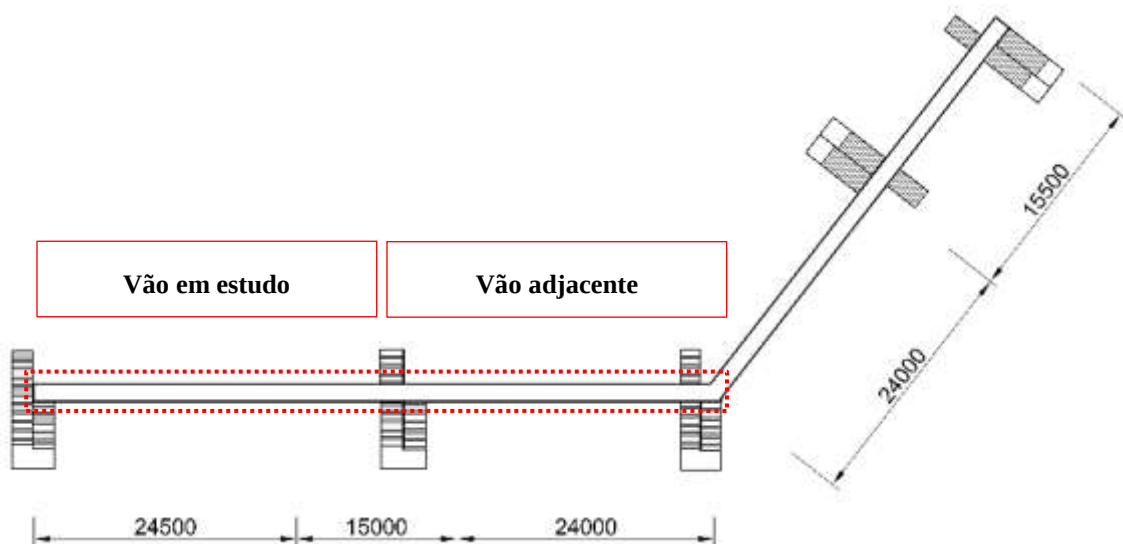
Projeto da Passarela. Vista Superior: trecho analisado em vermelho.
